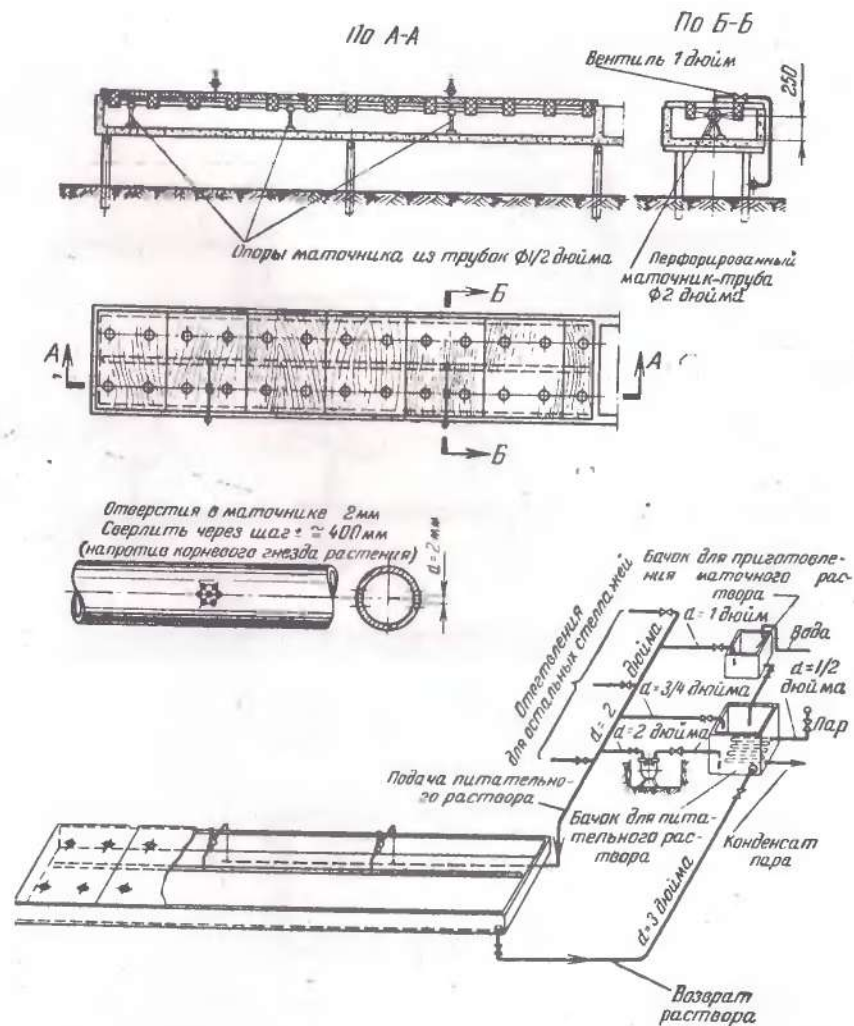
Схема устройства узла питания и оборудования стеллажей и углубленных котлованов.
